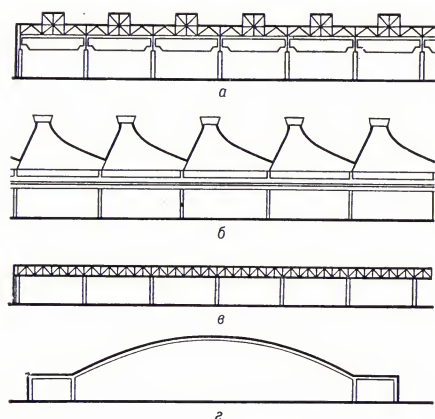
Одноэтажные промышленные здания: а — многопролётное крановое здание со световыми фонарями; б — многопролётное здание с аэрационными вытяжными шахтами; в — многопролётное бескрановое бесфонарное здание; г — здание зального типа.
